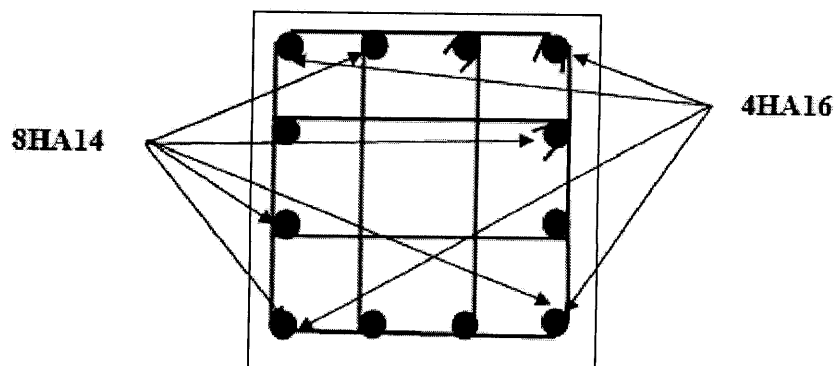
schéma de ferrailage des poteaux 50x45.
